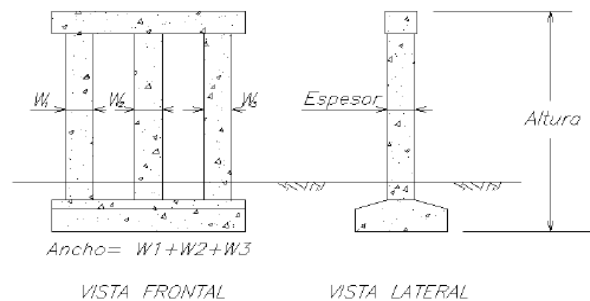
Vista frontal y lateral de una pila tipo columna múltiple (MOPT, 2007).
